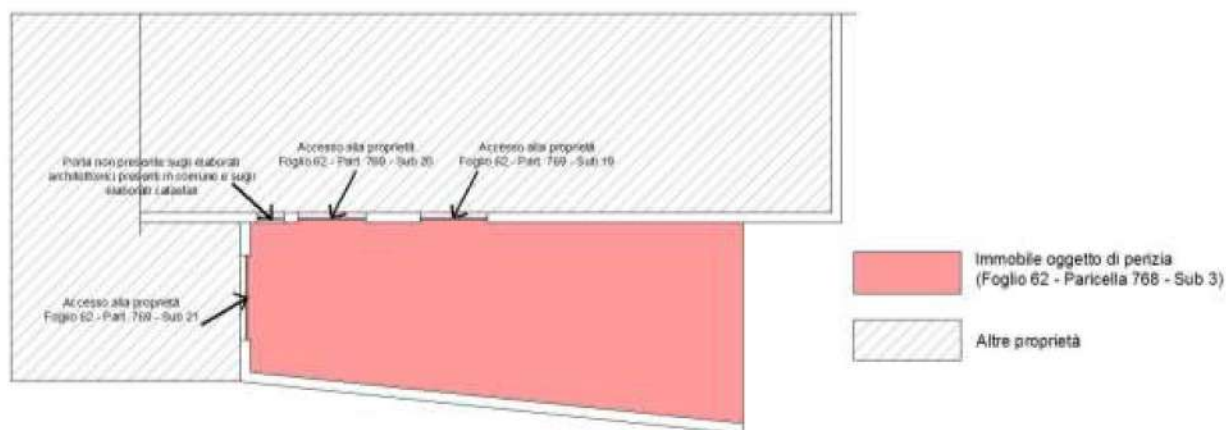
Planimetria rilevata immobile oggetto di perizia (ALLEGATO 6)
